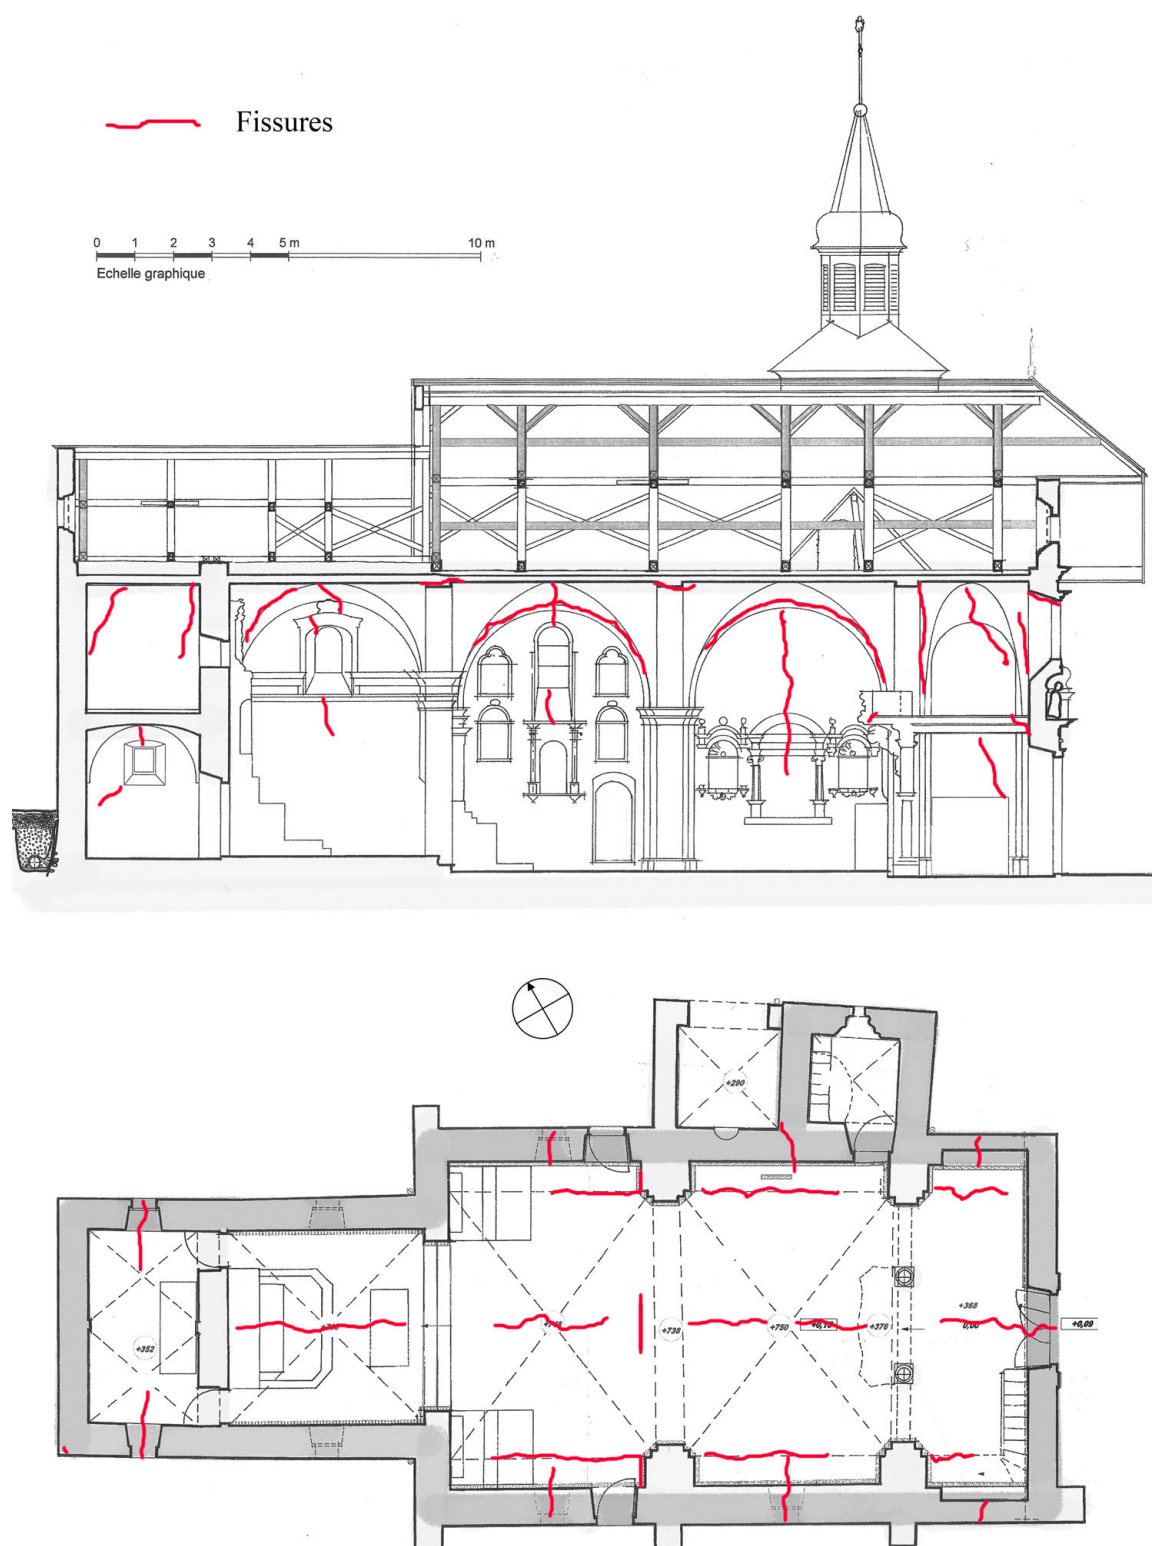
Relevé manuel des fissures intérieures de NDG. a) Plan : fissures longitudinales dans les voûtes et à leur jonction avec les arcs doubleaux le long des murs gouttereaux b) Coupe longitudinale coordonnée : fissures au droit des baies, actuelles ou bouchées. Fissures en biais à l'arrière de la façade principale.
